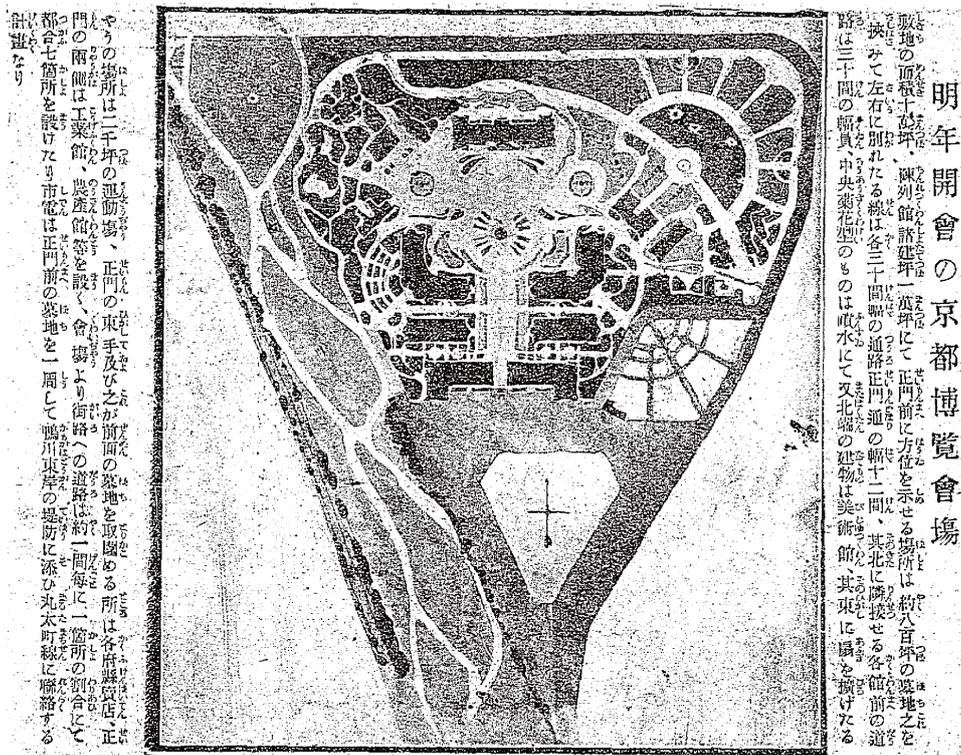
大博平面図 (大阪朝日新聞京都版 1913.5.30 付の記事)
